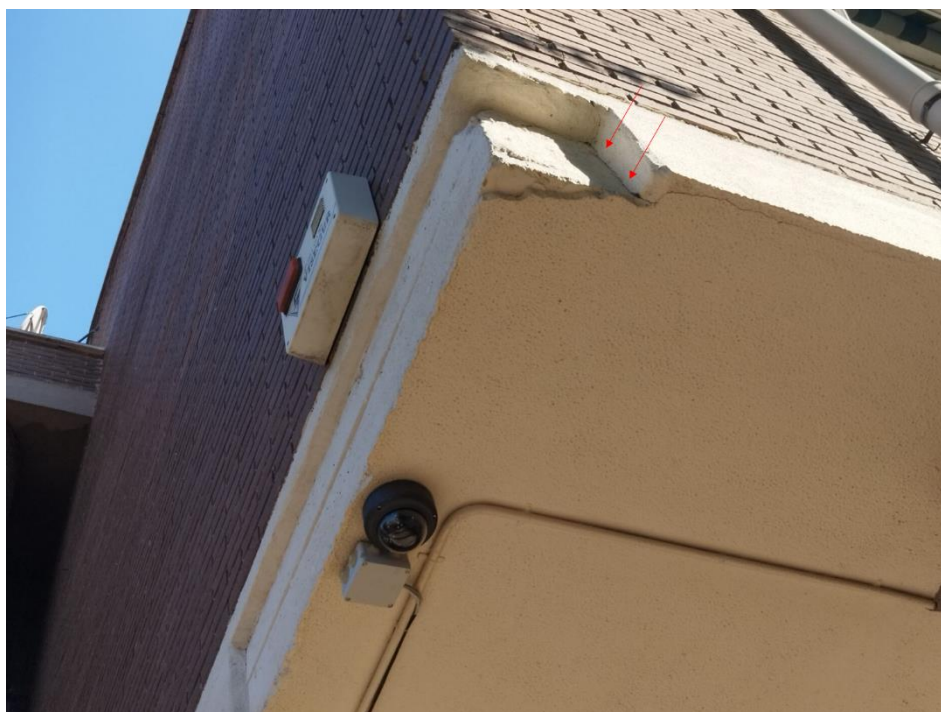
Desprendimiento del acabado de mortero del borde de forjado de la fachada, en la esquina opuesta a la de la posición de las fisuras objeto de estudio.
